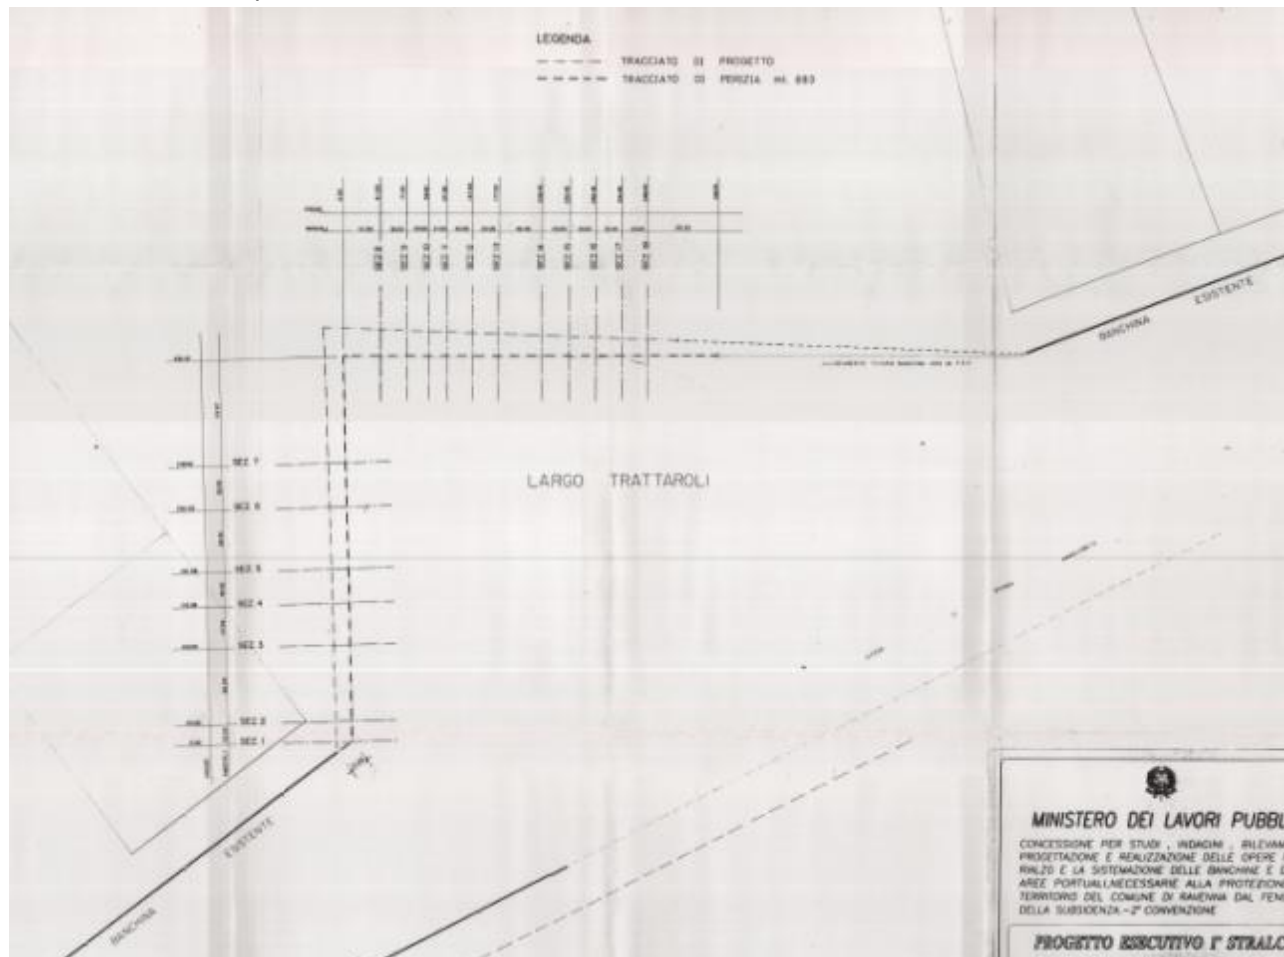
Planimetria dell'area con il tracciato di banchina previsto dalla Perizia del 1995
